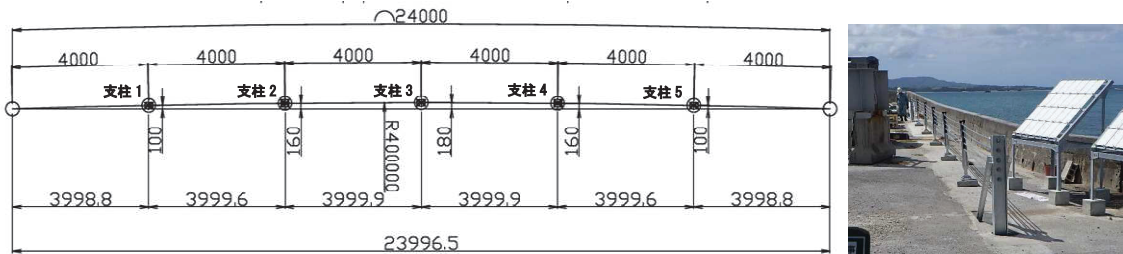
暴露供試体平面図 (単位: mm) と暴露供試体支柱設置状況
